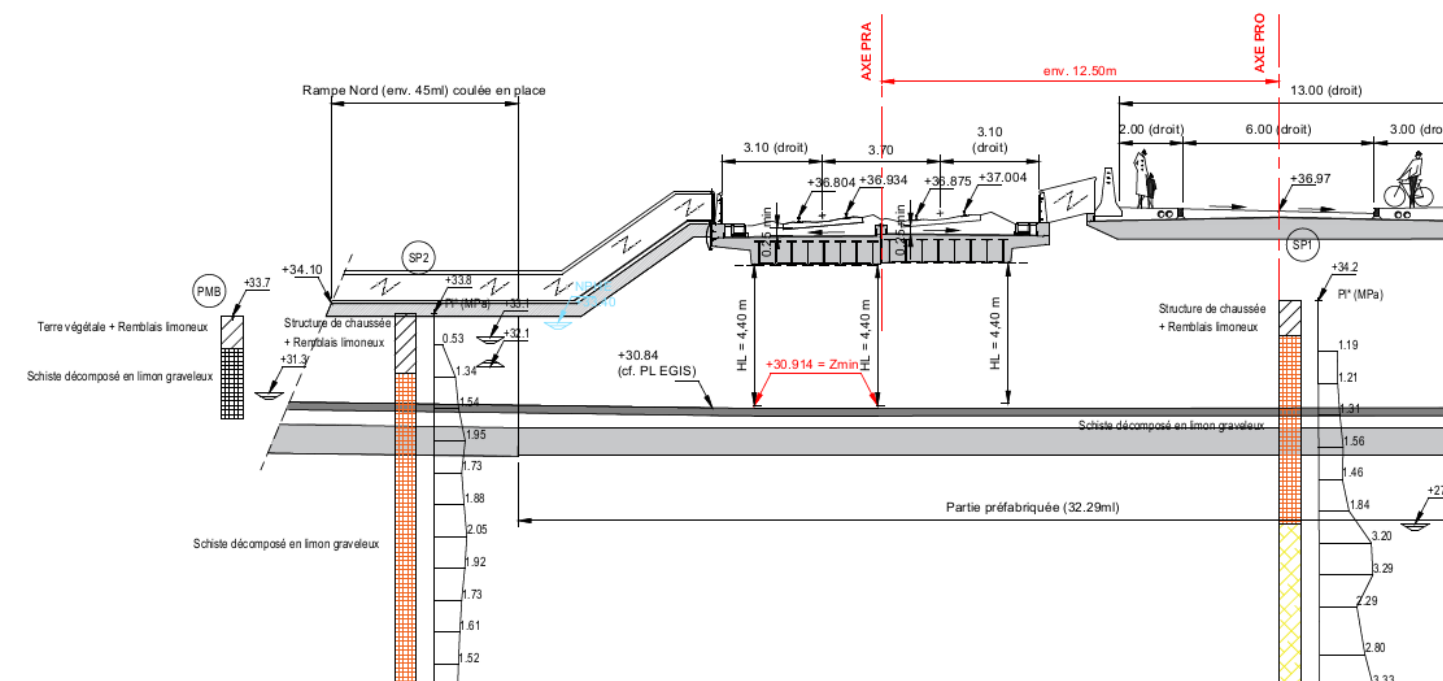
COUPE LONGITUDINALE DE LA SITUATION PROJETEE
